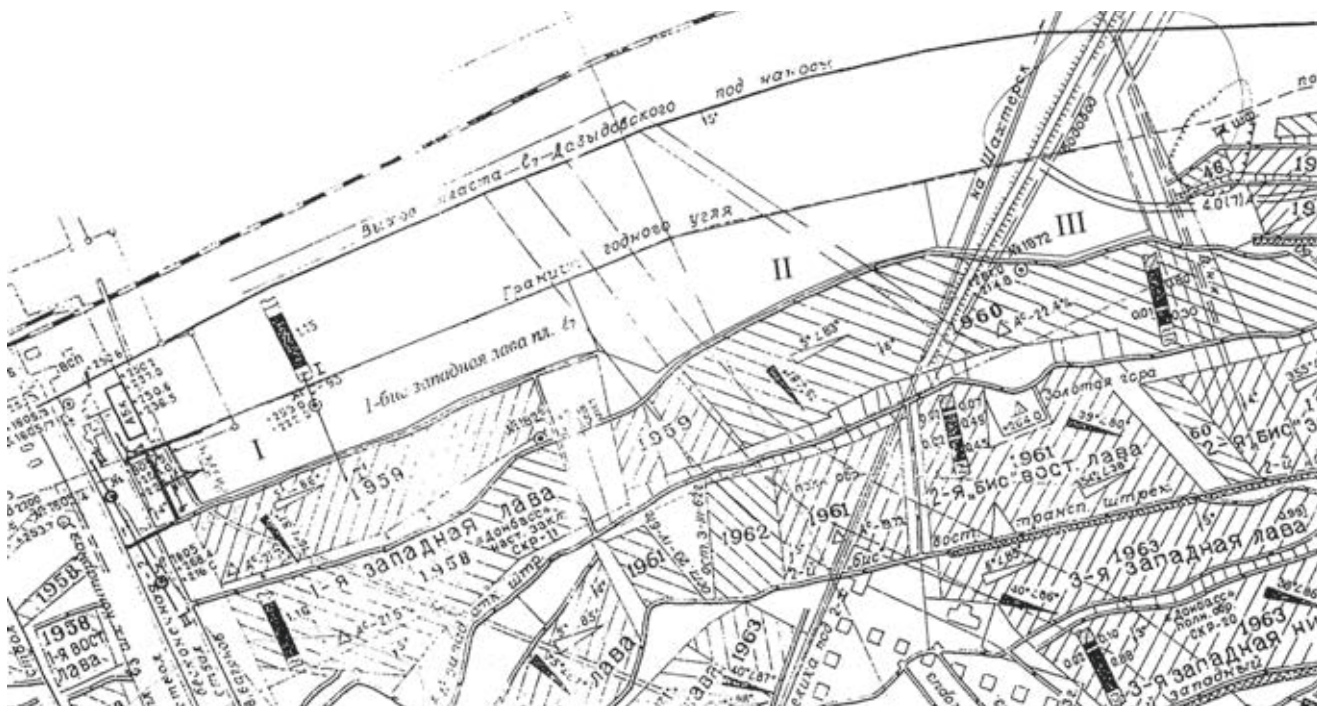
Фрагмент плана горных выработок пласта I_7 / Fig. 1. Fragment of the mining workings plan of seam I_7
